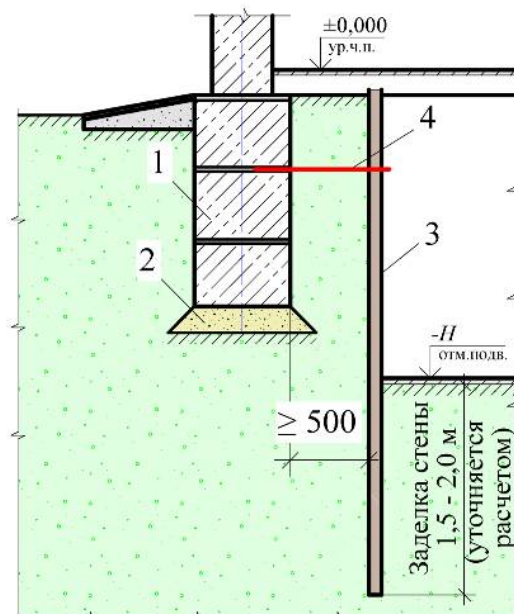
Устройство шпунтовой стенки с целью увеличения высоты подвала: 1 - существующий фундамент; 2 – щебеночная подготовка; 3 – шпунтовая стенка; 4 – анкер для крепления шпунтовой стенки к фундаменту, горизонтальная связь
